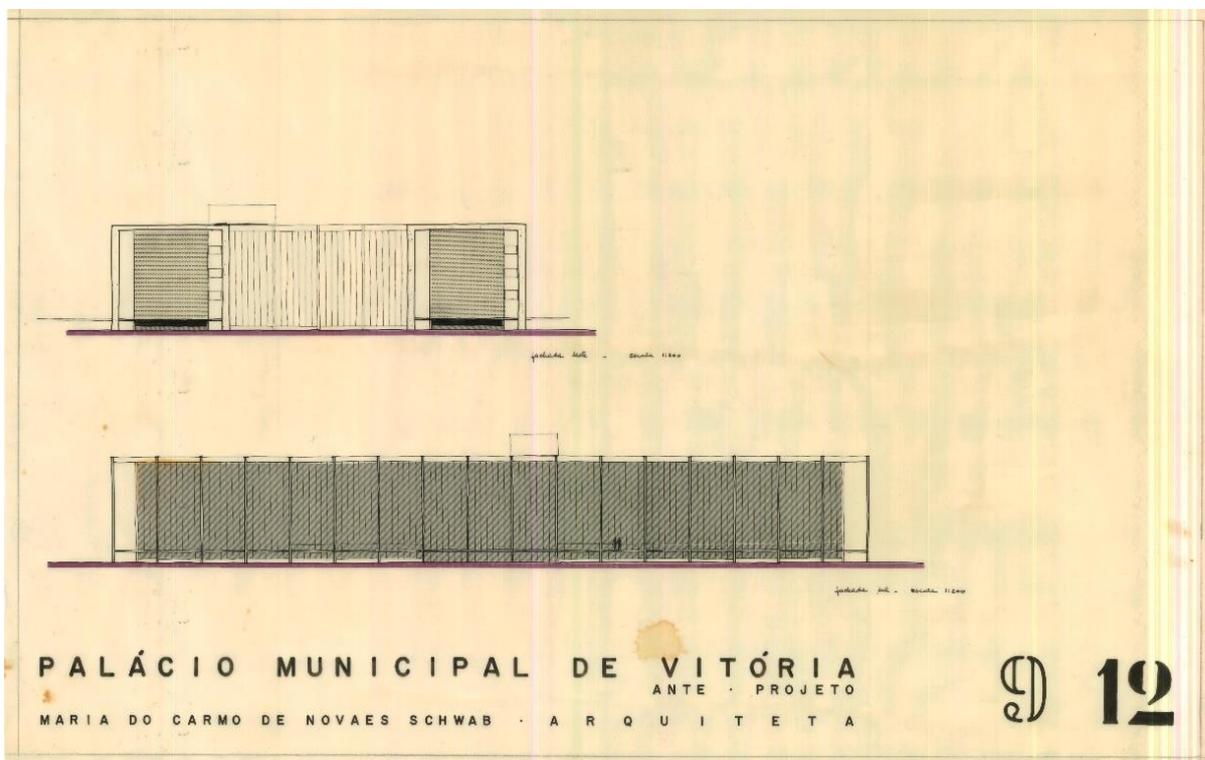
Prancha 9/12, constando as fachadas sul (principal de acesso) e leste (a partir da rua lateral), destacando-se a estrutura externa caracterizado da forma final.
